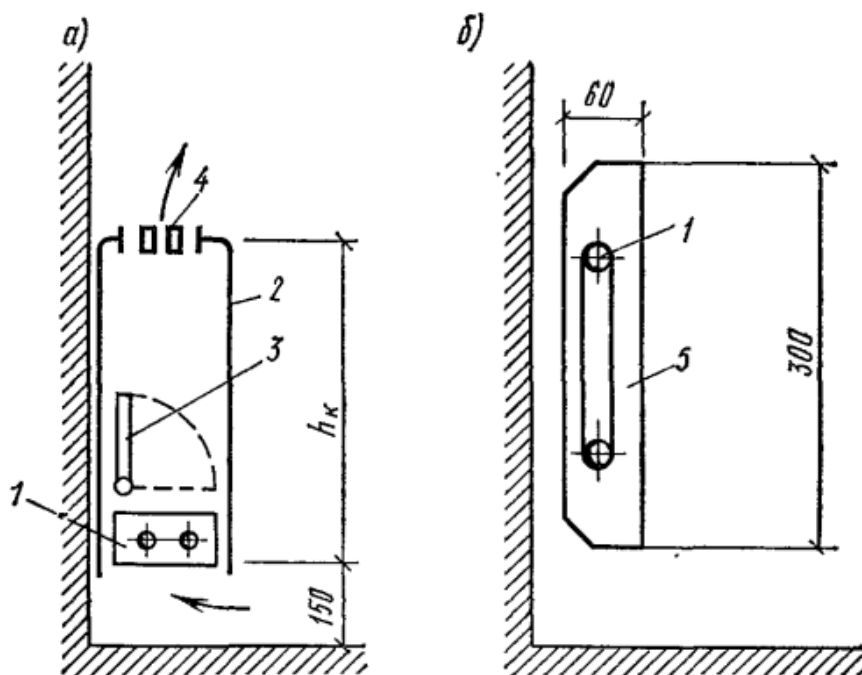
Конвектор открыторасположенный (б) и в кожухе (а): 1 – нагревательный элемент, 2 – кожух (высотой h_k), 3 – регулирующий клапан, 4 – отверстие кожуха, 5 – ребрение
